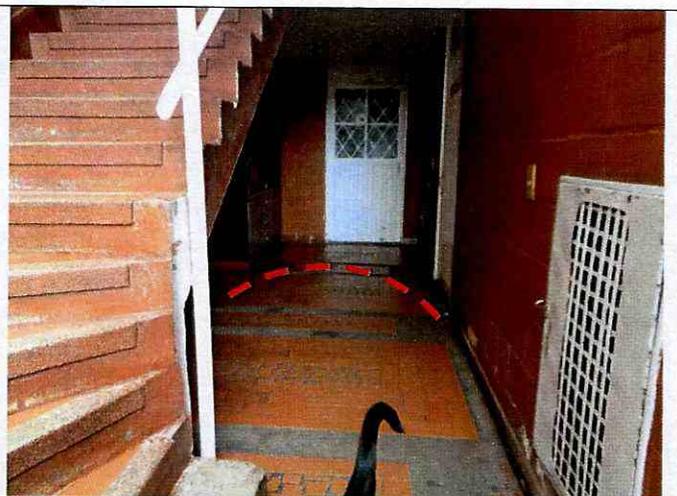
Vista del levantamiento del recubrimiento de enchape de la placa de piso del acceso a la torres 15
